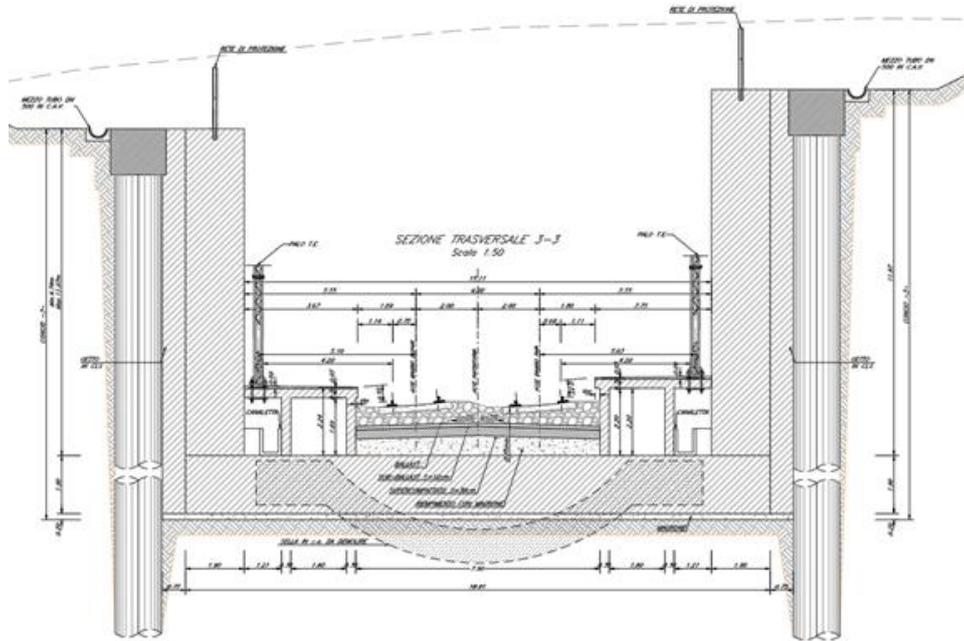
Sezione trasversale muro ad U (Concio 1) – Grottaminarda lato Bari
